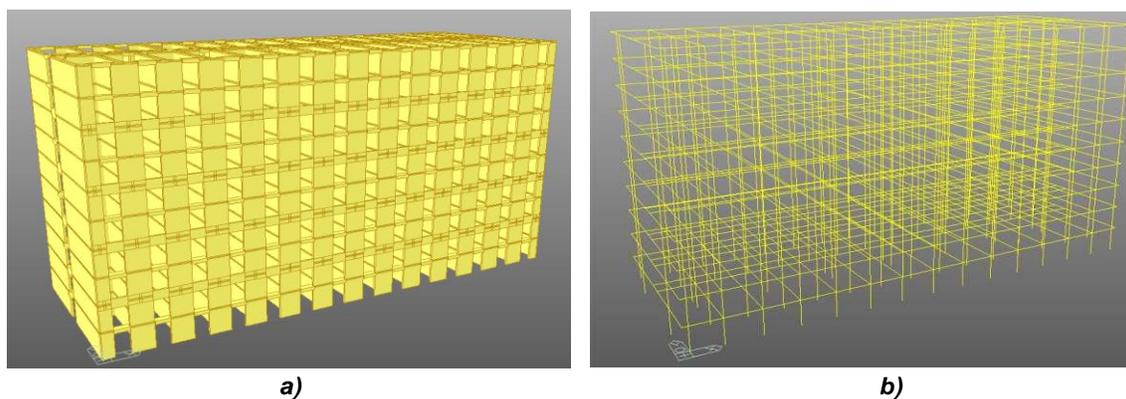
Trabajo integrado de fachada y pasillos en la dirección larga
